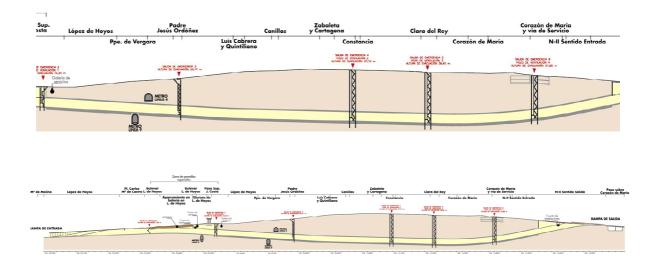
Alzado de la zona de túnel y alzado general del túnel viario
